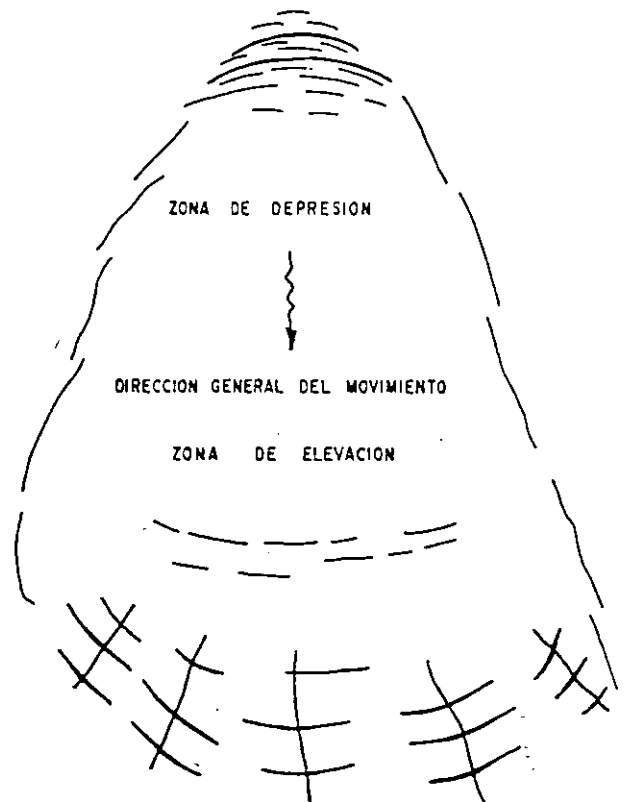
Planta típica de agrietamiento en un deslizamiento de tierra (Ref. 8).
